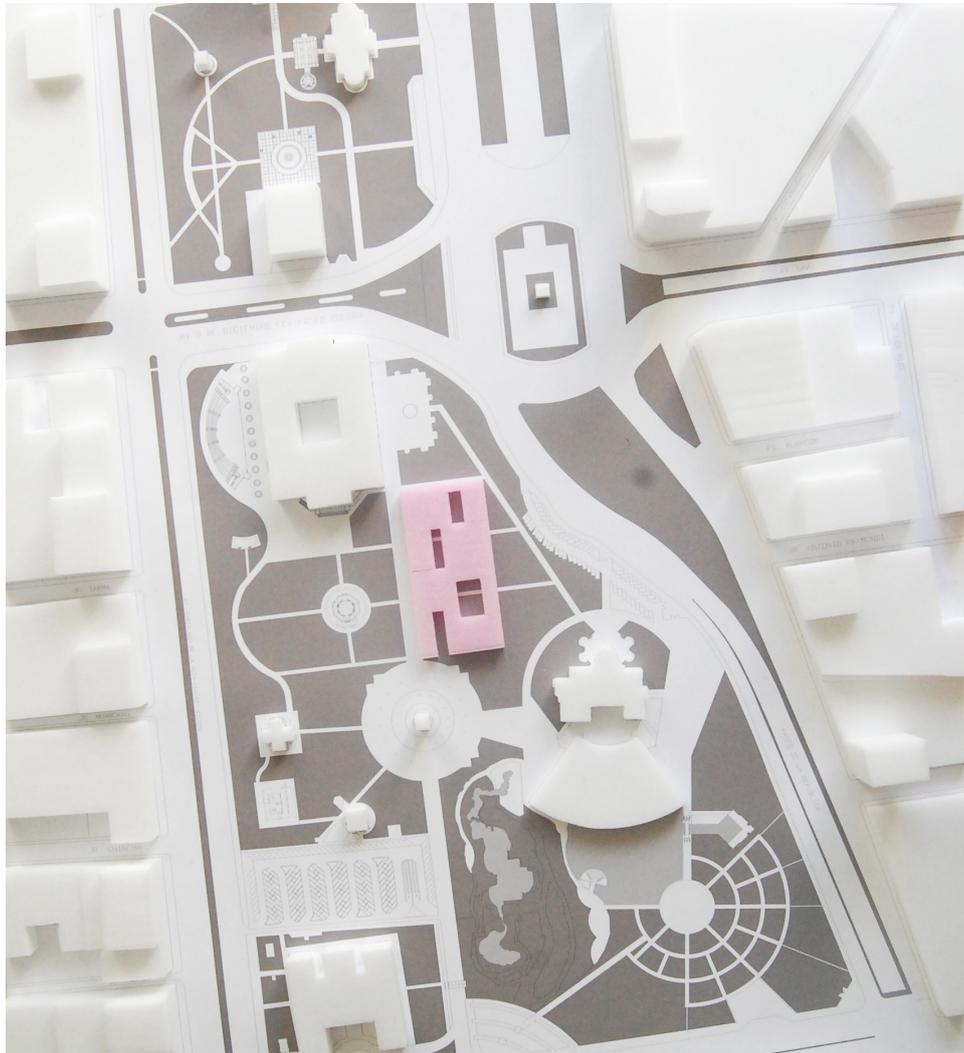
Modellfoto Draufsicht Der horizontale Komplex, rechteckig
